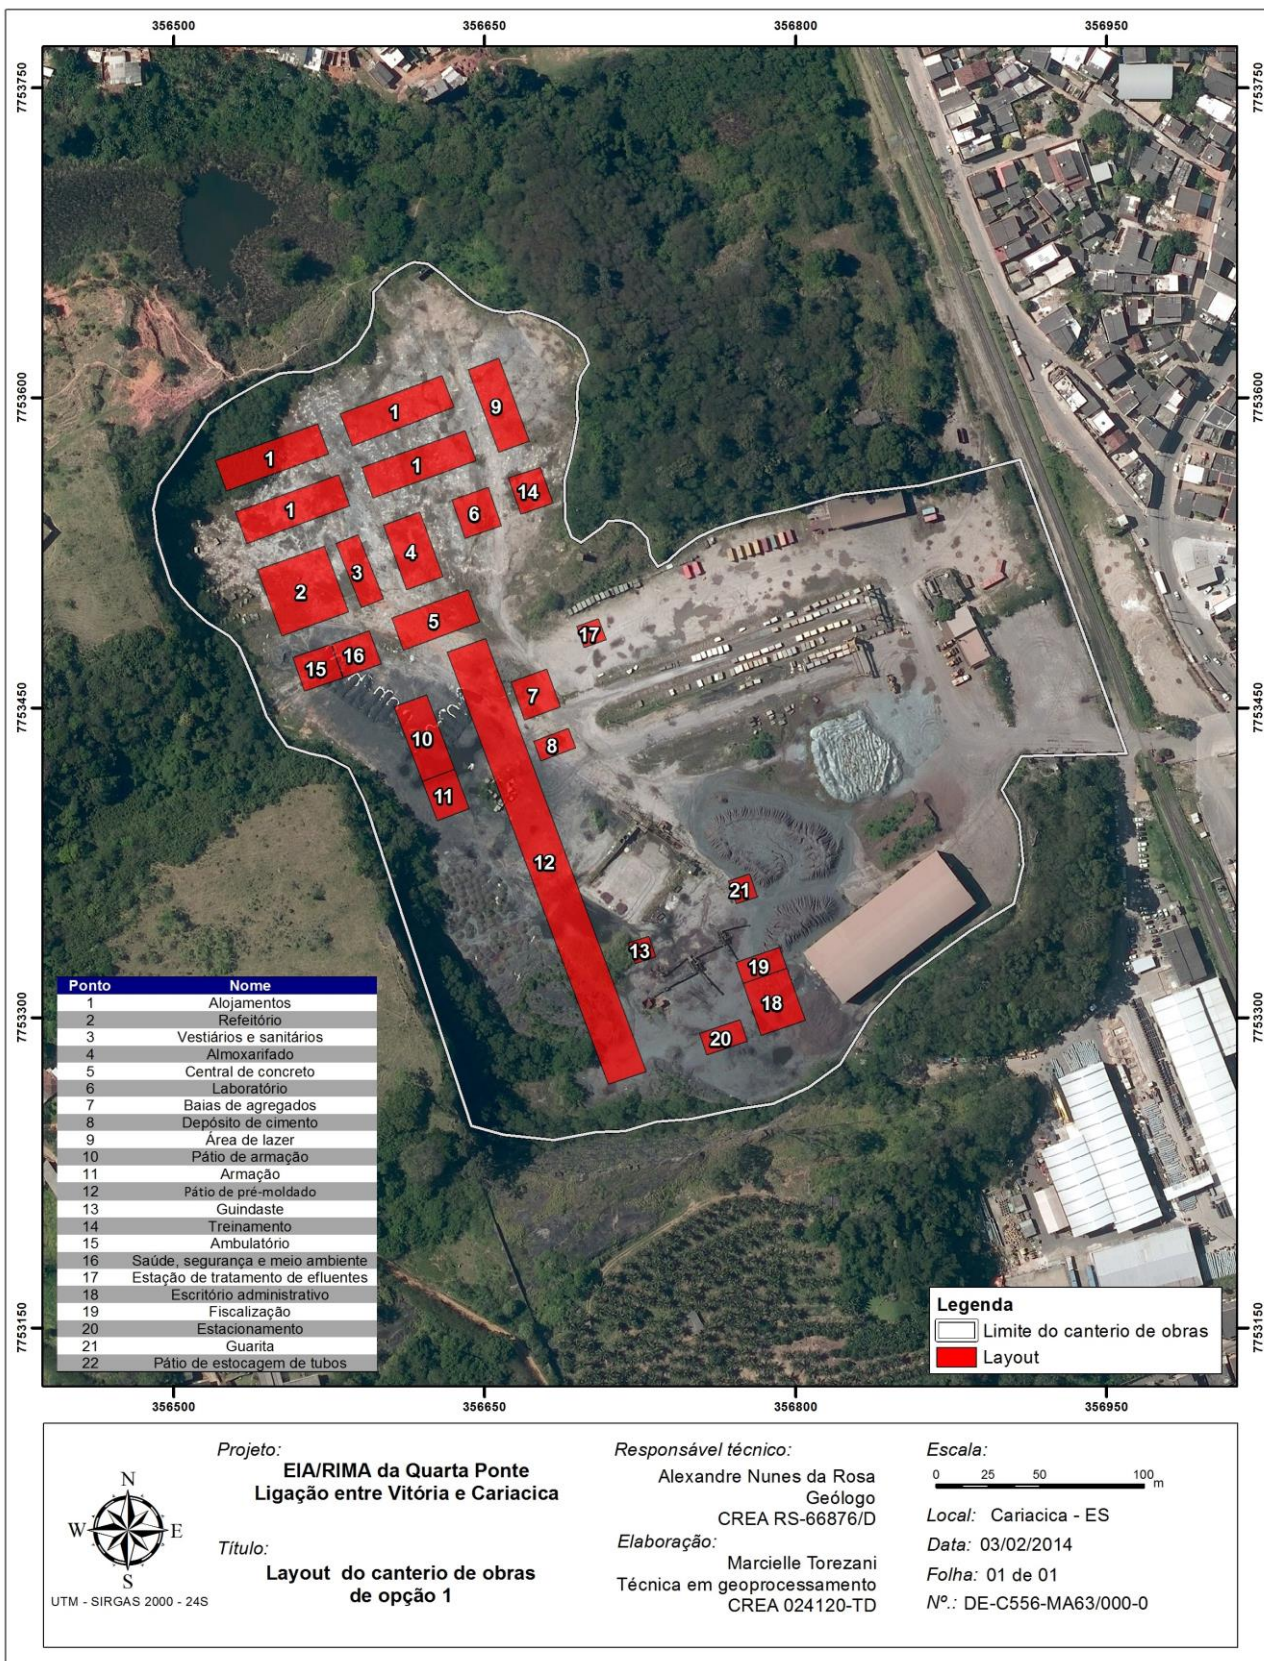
Layout da Opção 1 do Canteiro de Obras.
